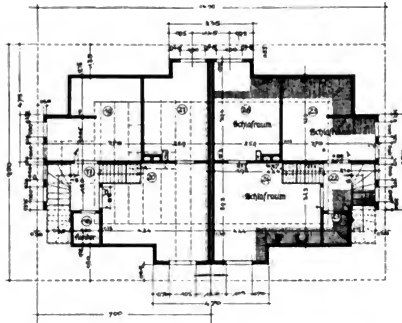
Grundriß zu Abb. 90. Obergeschoß.
